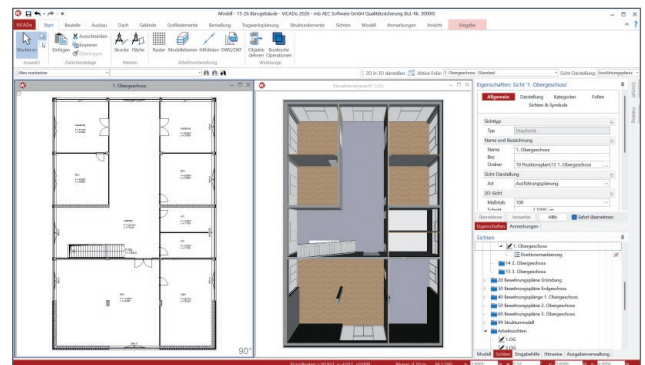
Abgeleiteter Grundriss und Gebäudemodell
